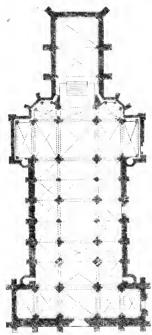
Grundrifs des Münfters zu Schlettstadt.
